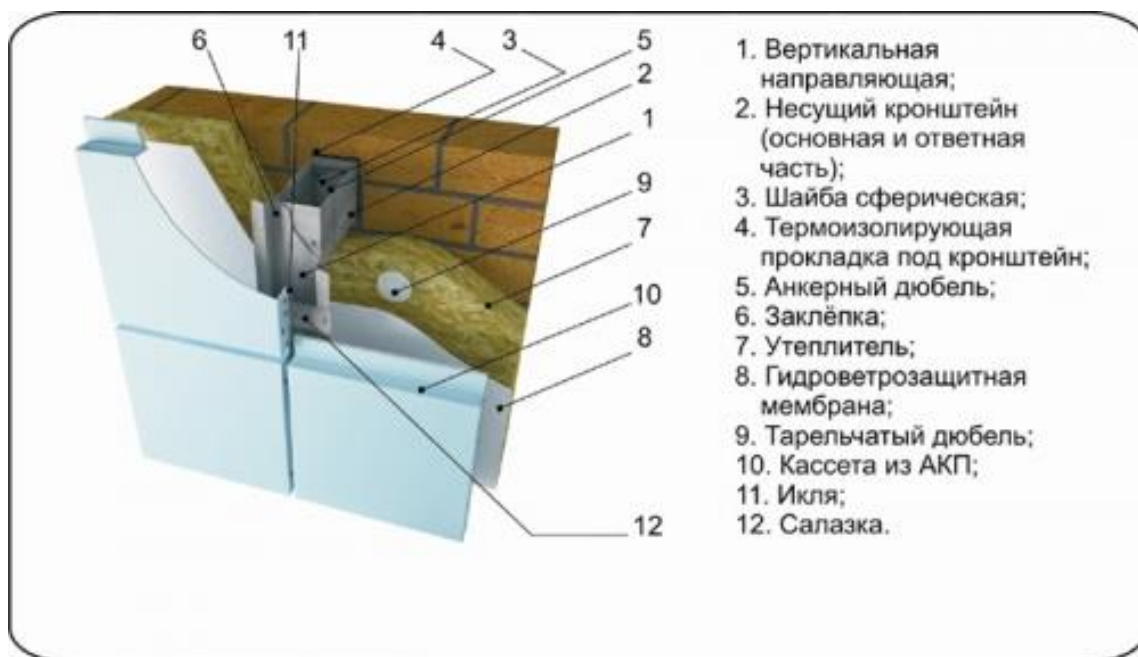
Технология монтажа конструкции вентилируемого фасада
